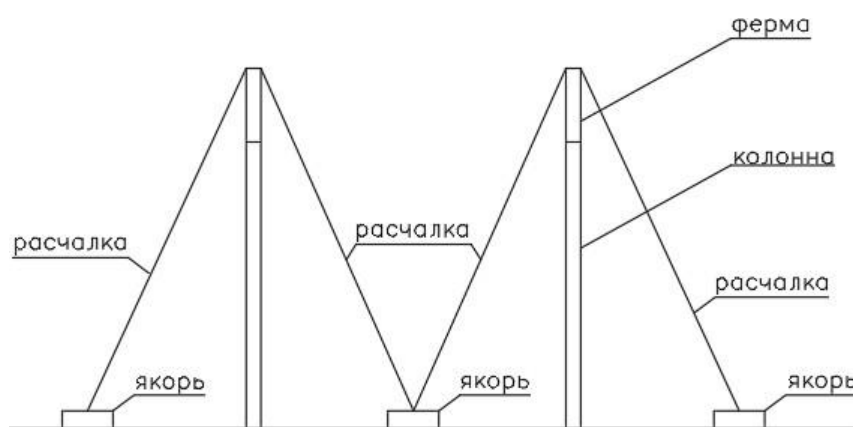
Временное крепление первых двух ферм в пролете
